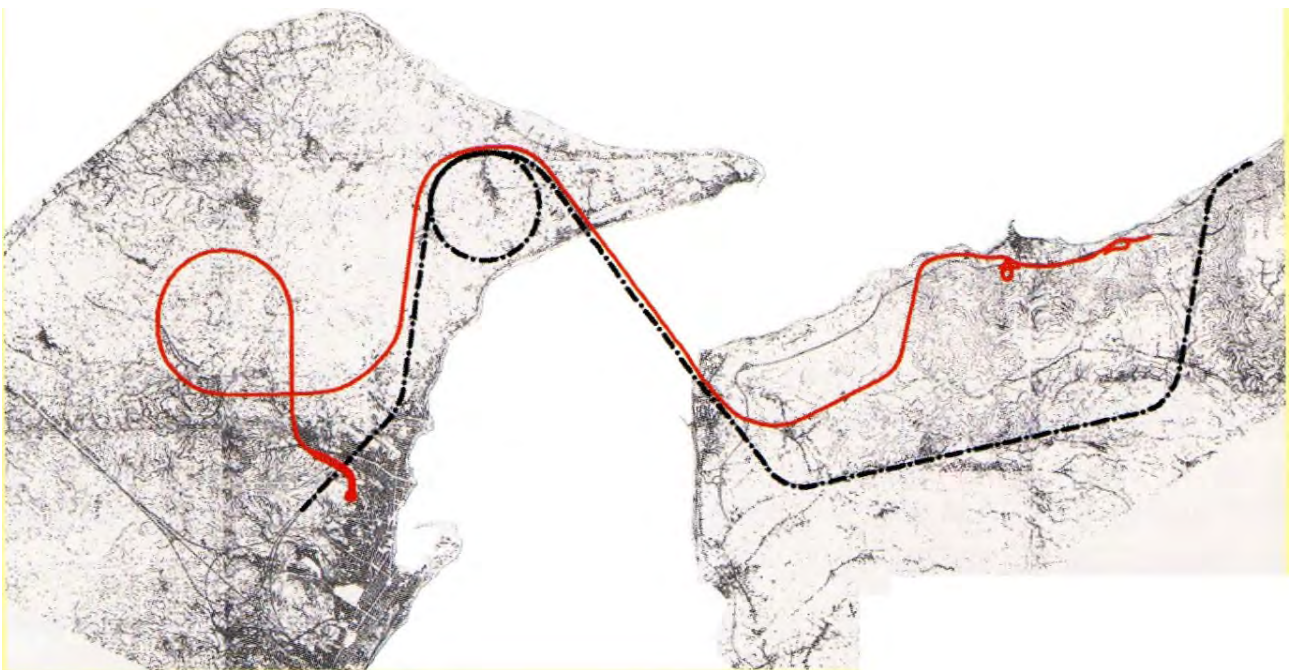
Planimetria dei tracciati stradali e ferroviari in tunnel sottomarino ipotizzati dalla società Stretto di Messina
